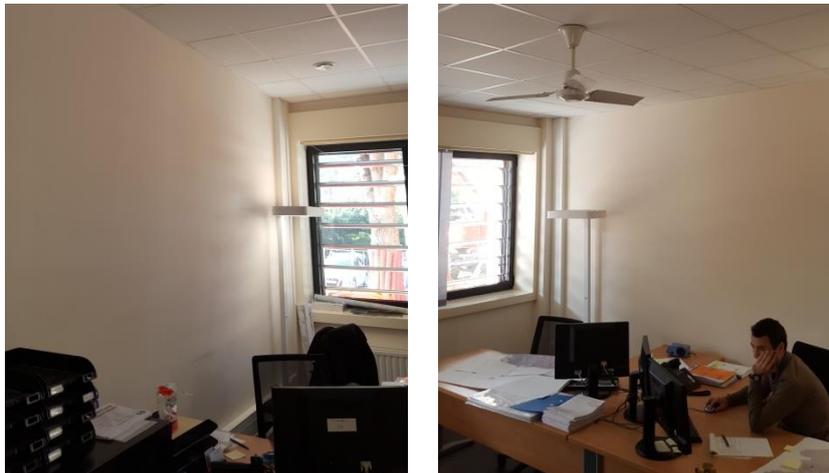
Bureau SDC3 (n°20) au rez-de-chaussée
